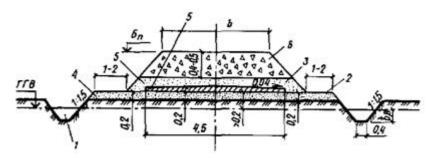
Конструкции насыпи с гидроизоляционным покрытием 1 - канава; 2 - полка; 3, 4 - верхний и нижний песчаные слои; 5 - суглинистый слой; б - балластный слой; ГГВ - горизонт грунтовых вод
